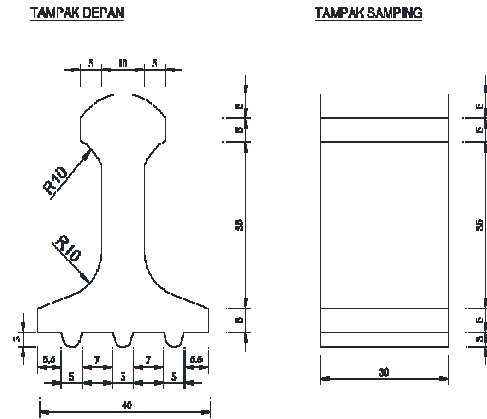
Modul Dinding atau Lantai Tipe-T Beton Pracetak Modular
